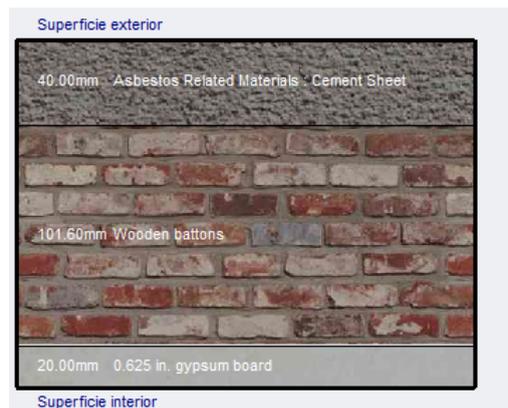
Cubierta,, Elaboración propia, DesignBuilder
